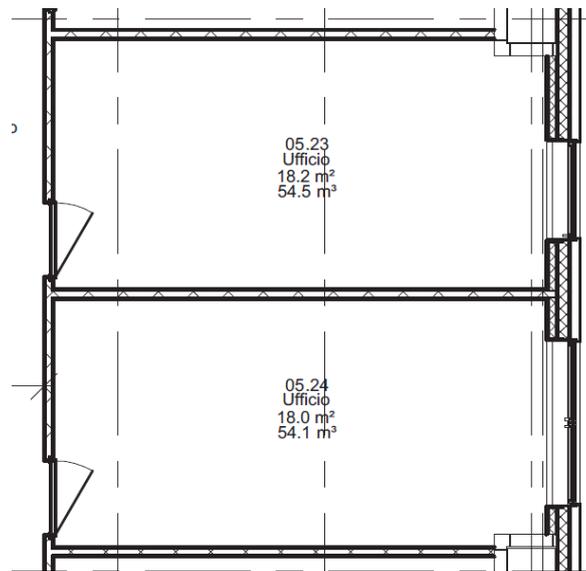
Planimetria locali Edificio A Piani tipo 5-7-9-11
